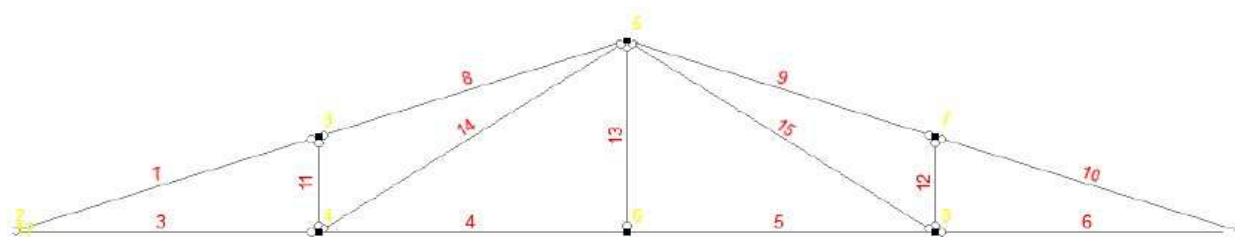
Расчетная схема фермы с клееным верхним поясом
